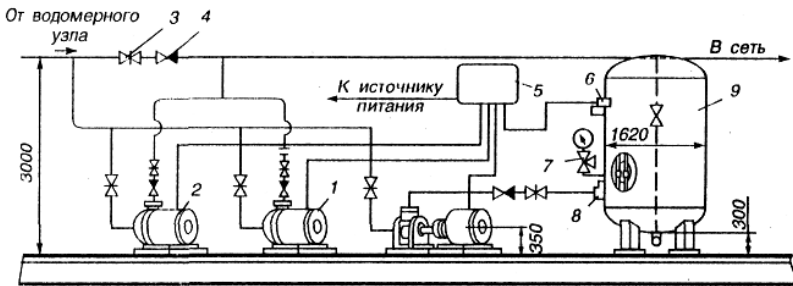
Схема типовой насосной установки с гидропневматическими баками: 1 – рабочие насосные агрегаты; 2 – резервный насосный агрегат; 3 – обратный клапан; 4 – задвижка; 5 – шкаф управления; 6 – реле давления; 7 – трехходовой кран с манометром; 8 – струйный регулятор запаса воздуха; 9 – гидропневматический бак
